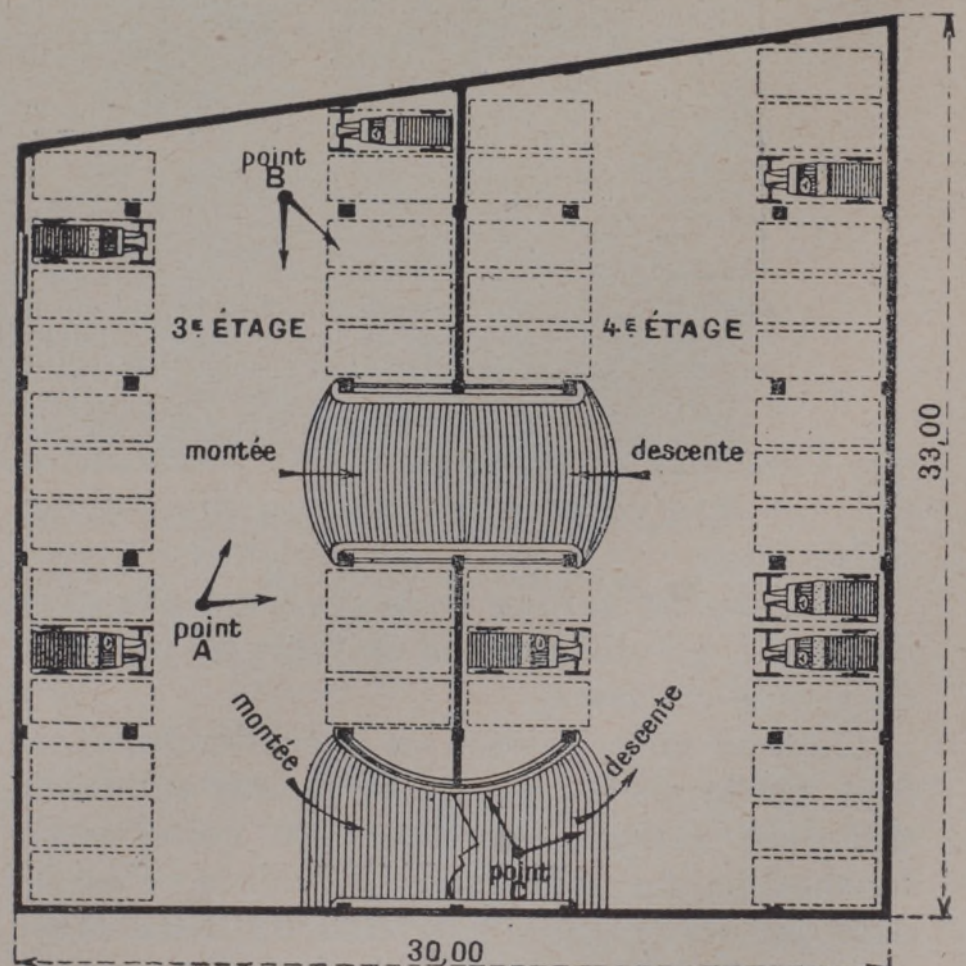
Fig. V. — Plan des 3^e et 4^e étages d'un garage établi d'après le système Humy Motorramp.
